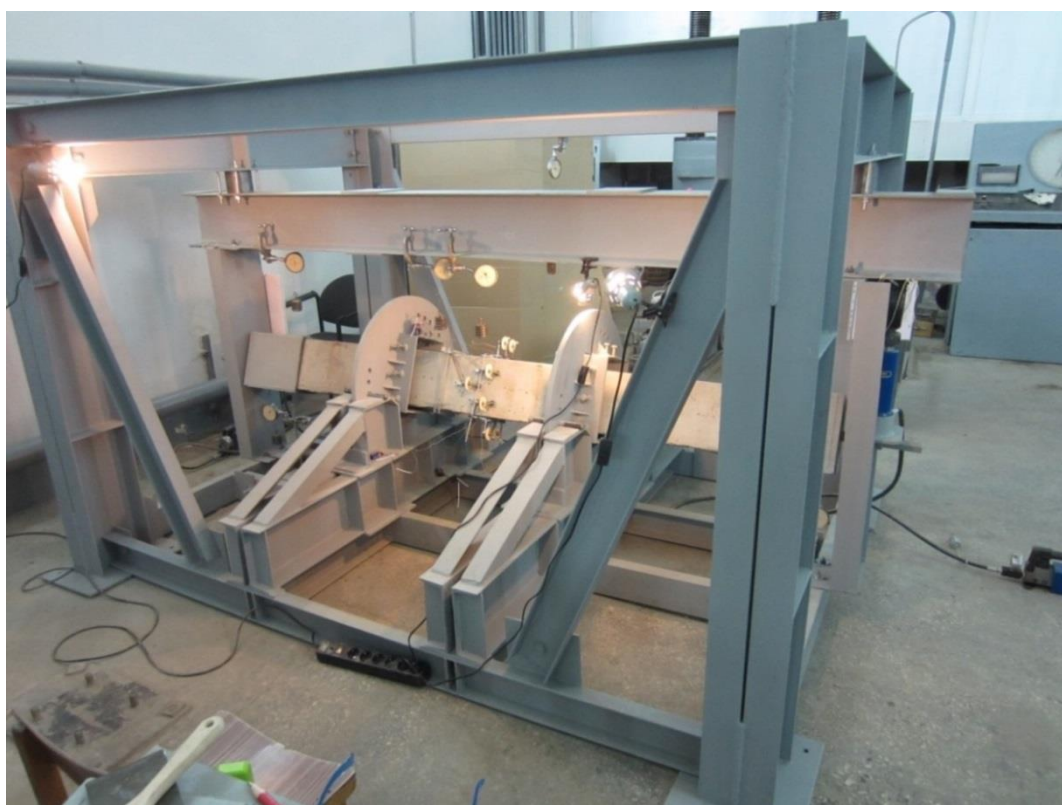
Общий вид образца-балки в процессе испытания сбоку
